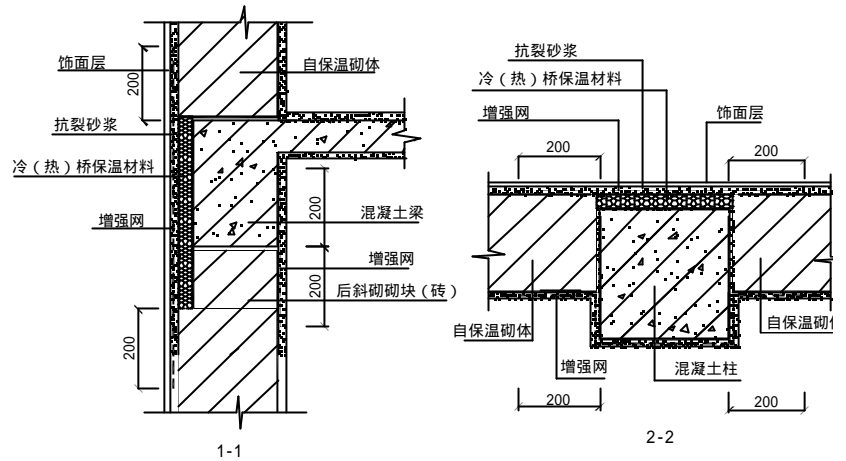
自保温墙体与混凝土梁、柱、墙交接面抗裂加强处理
